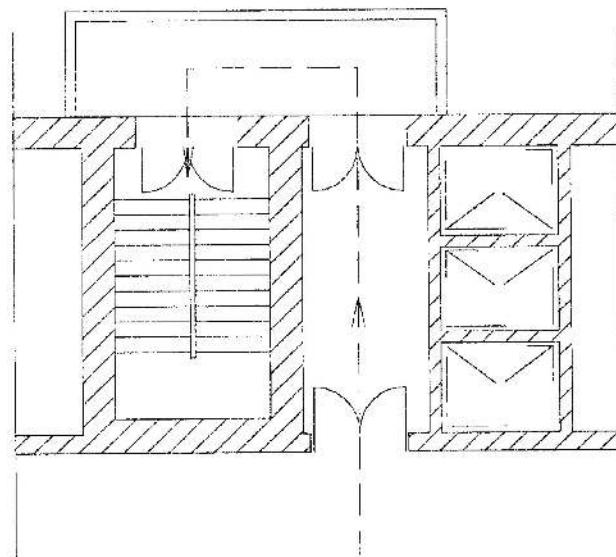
Вариант решения незадымляемой лестничной клетки через балкон (подобные варианты – через лоджию, через галерею в зданиях галерейного типа, лестничная клетка, расположенная вне здания)
